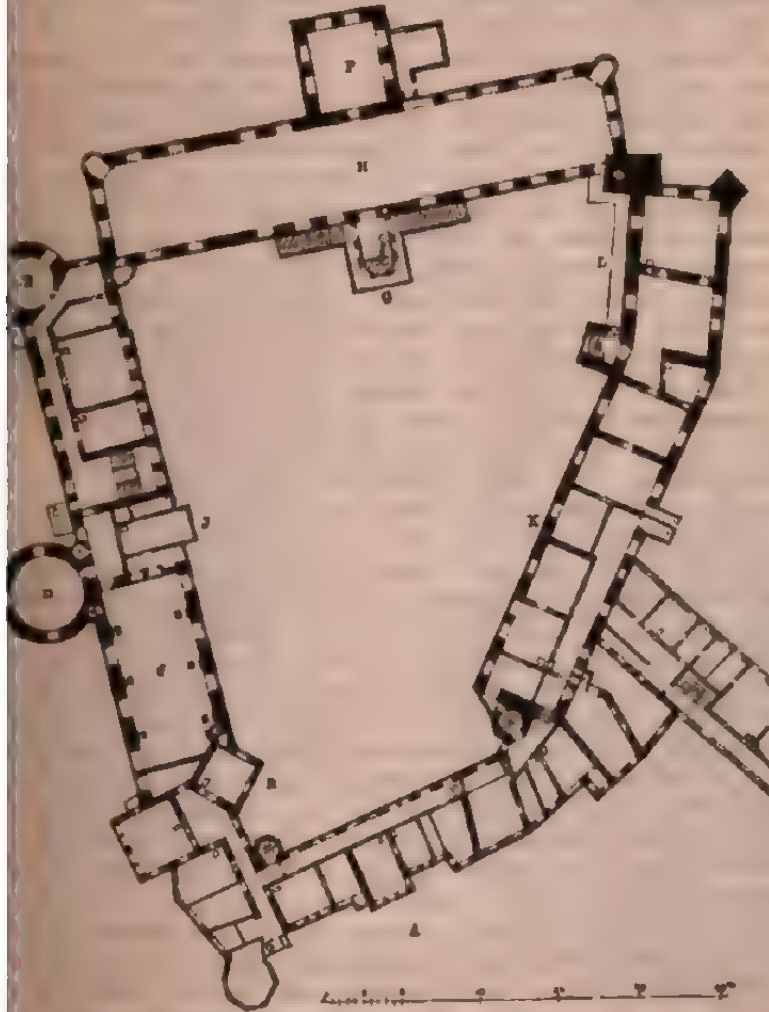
Schloss zu Torgau. Grundriss des 1. Stockes.
